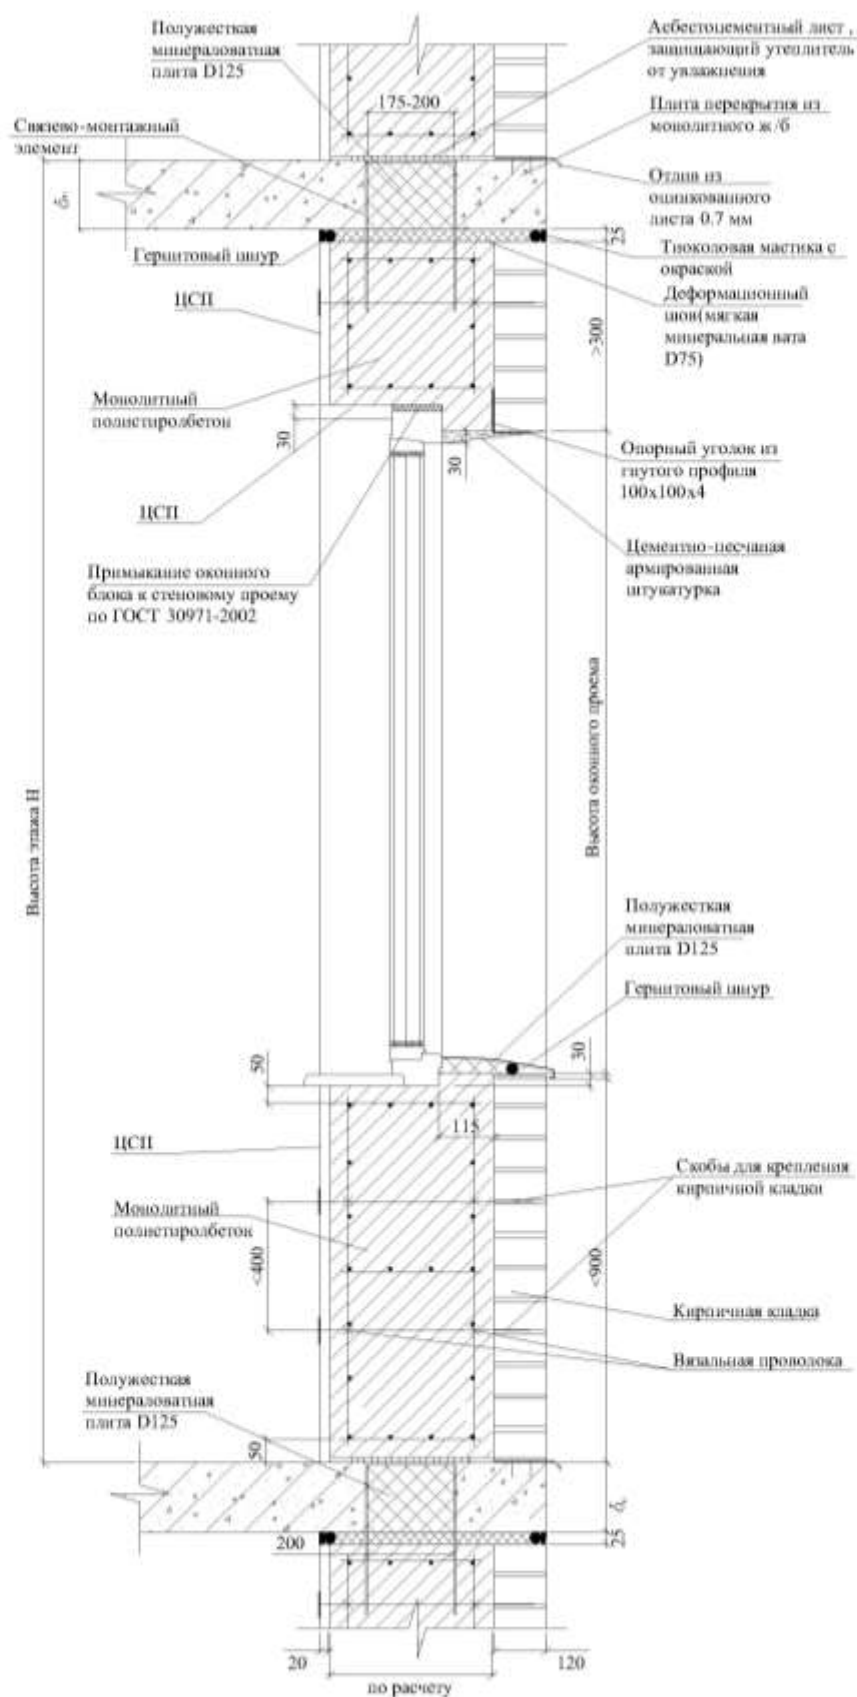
Ненесущая стена из монолитного полистиролбетона с кирпичной облицовкой фасада и несъемной опалубкой из ЦСП. Вертикальный разрез по оконному проему
